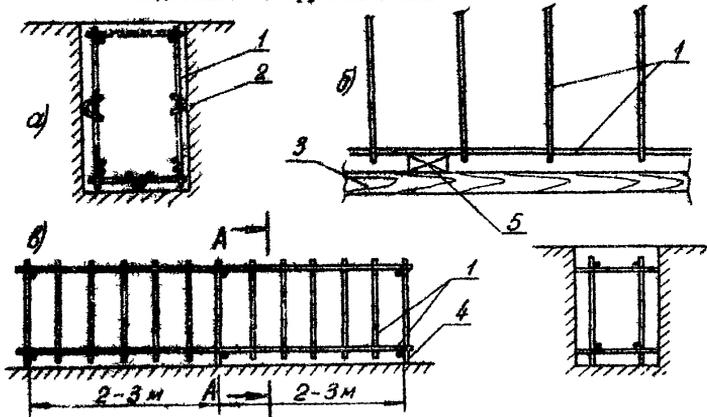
Способы обеспечения необходимого защитного слоя в железобетонных конструкциях
